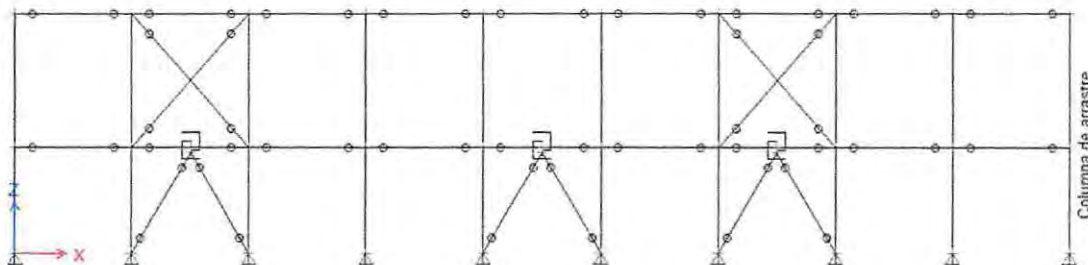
Modelo de análisis plano sistema T-Adas con columna de arrastre.
